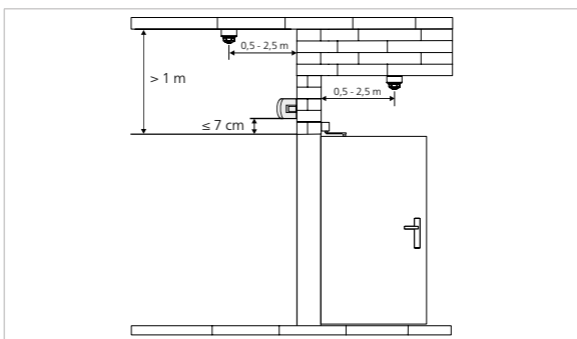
Montagevorgaben mit 2 Deckenrauchschaltern
